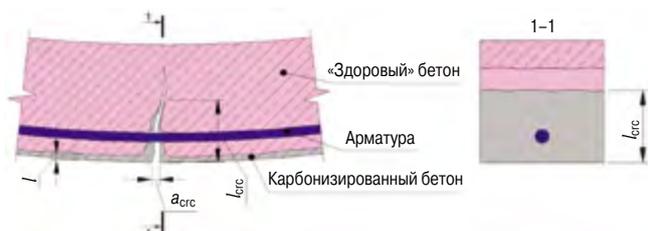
Изгибаемый железобетонный элемент с трещиной
